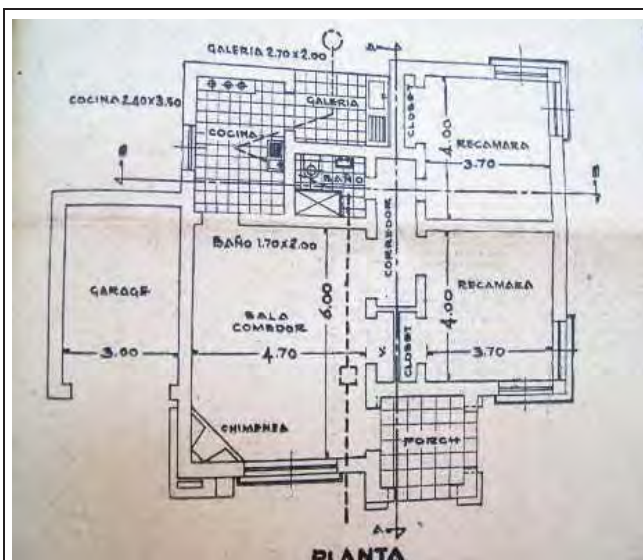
Planta arquitectónica de vivienda moderna en "Chalet".
